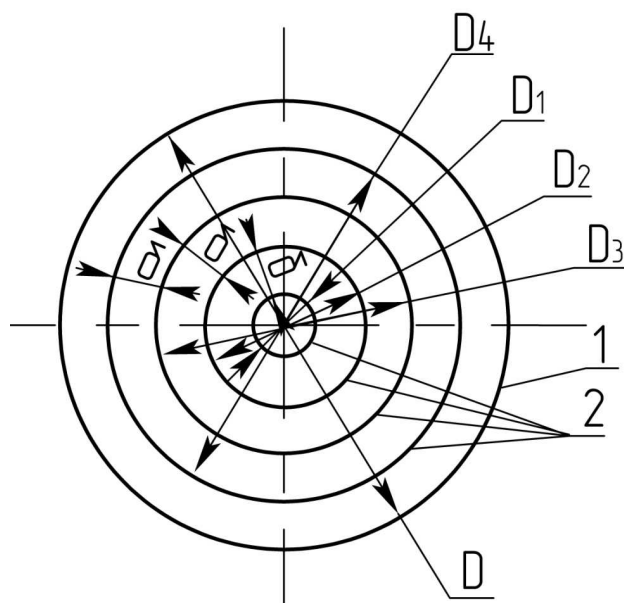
Поперечный разрез по А-А колонны с трубчатыми рукавами предлагаемой конструкции
